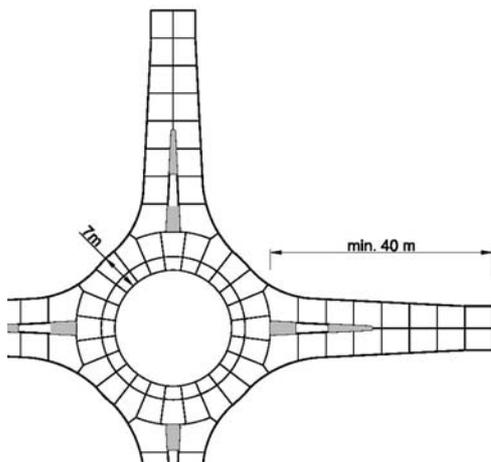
Kreisverkehrsarme auf eine Länge von min. 40 m in Beton ausführen [2]
